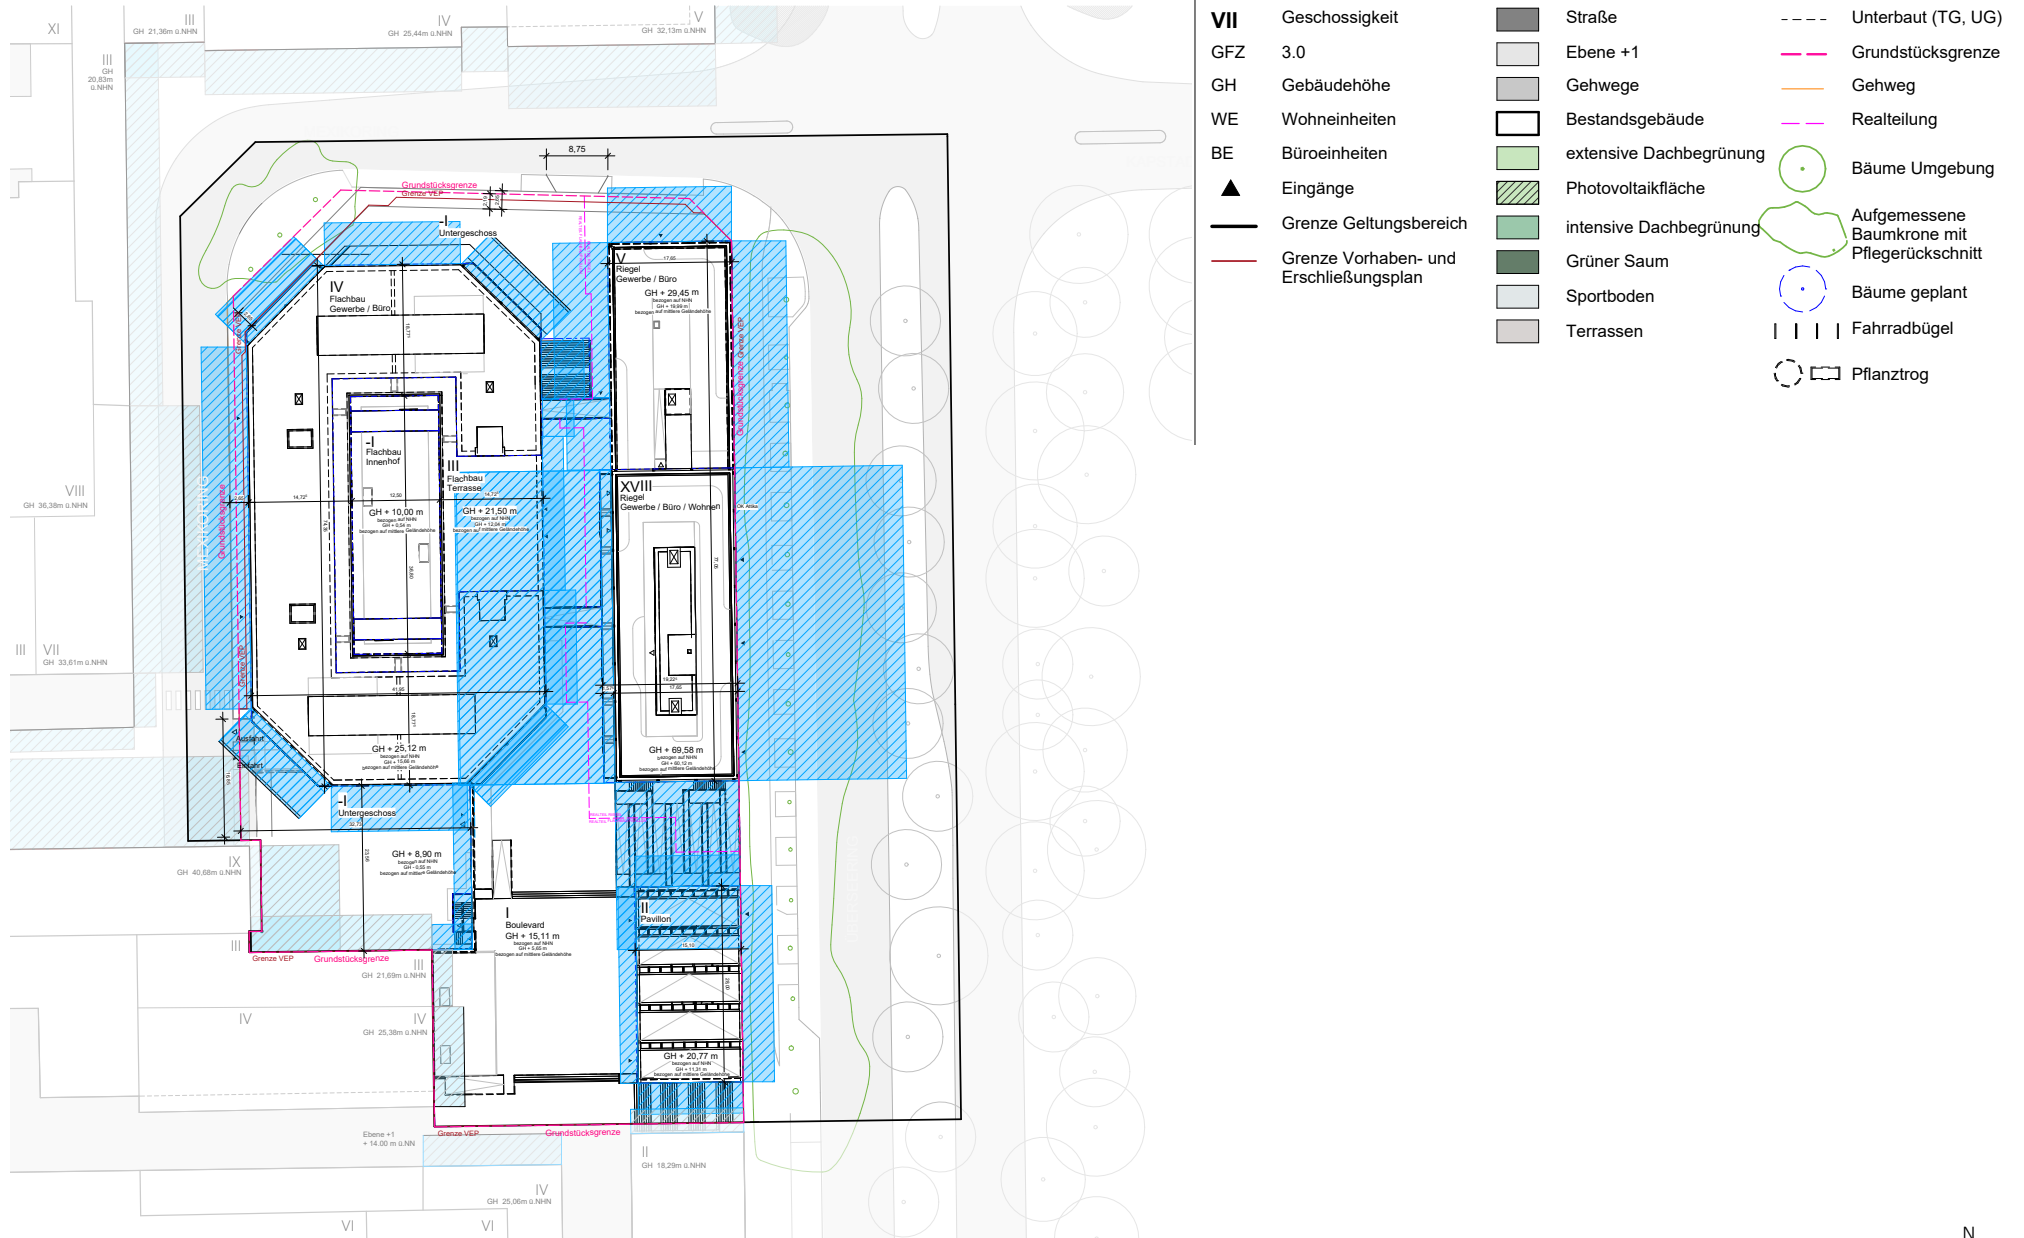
Ausschnitt Abstandsflächenplan. Blrm Architekt\*innen GmbH, Stand 30.01.2024.
